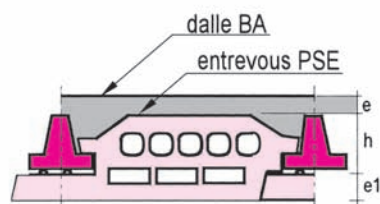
Plancher sur vide sanitaire avec entrevous PSE à languette
